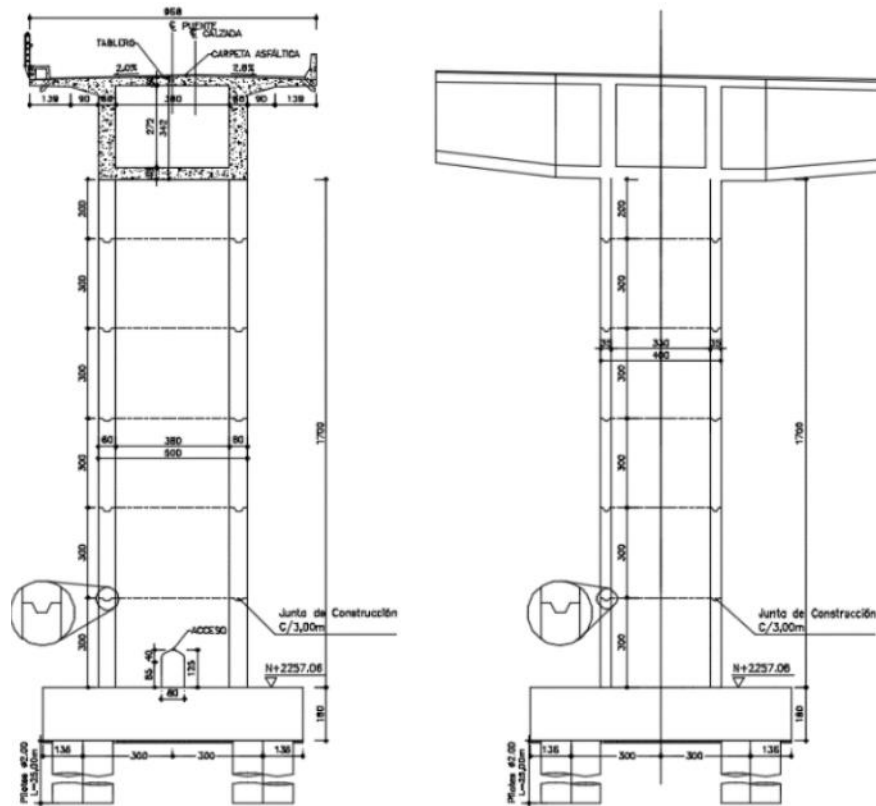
Geometría del apoyo eje 3 del puente Bermúdez.
